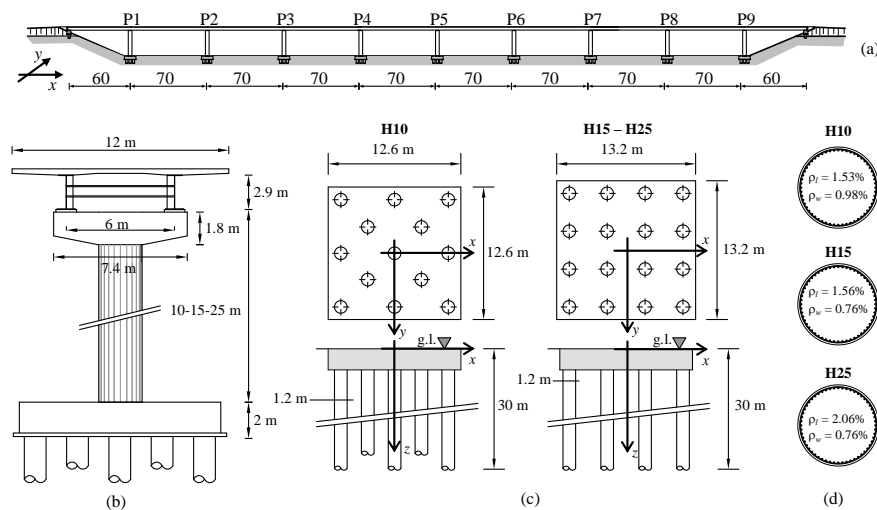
(a) Vista laterale del viadotto; (b) pila in elevazione; (c) fondazione (d) armature longitudinale e trasversale della pila
